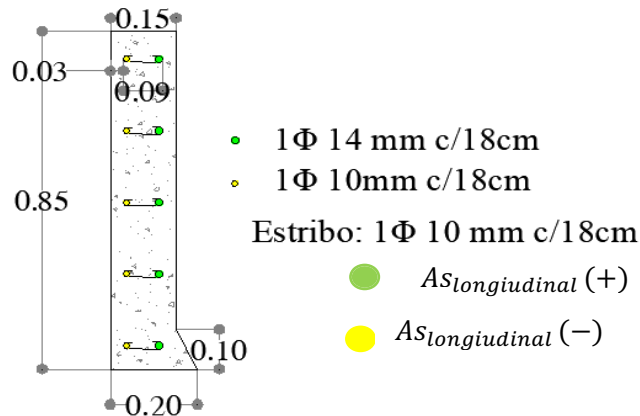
Armado de la protección de hormigón armado (maciza), sentido longitudinal
